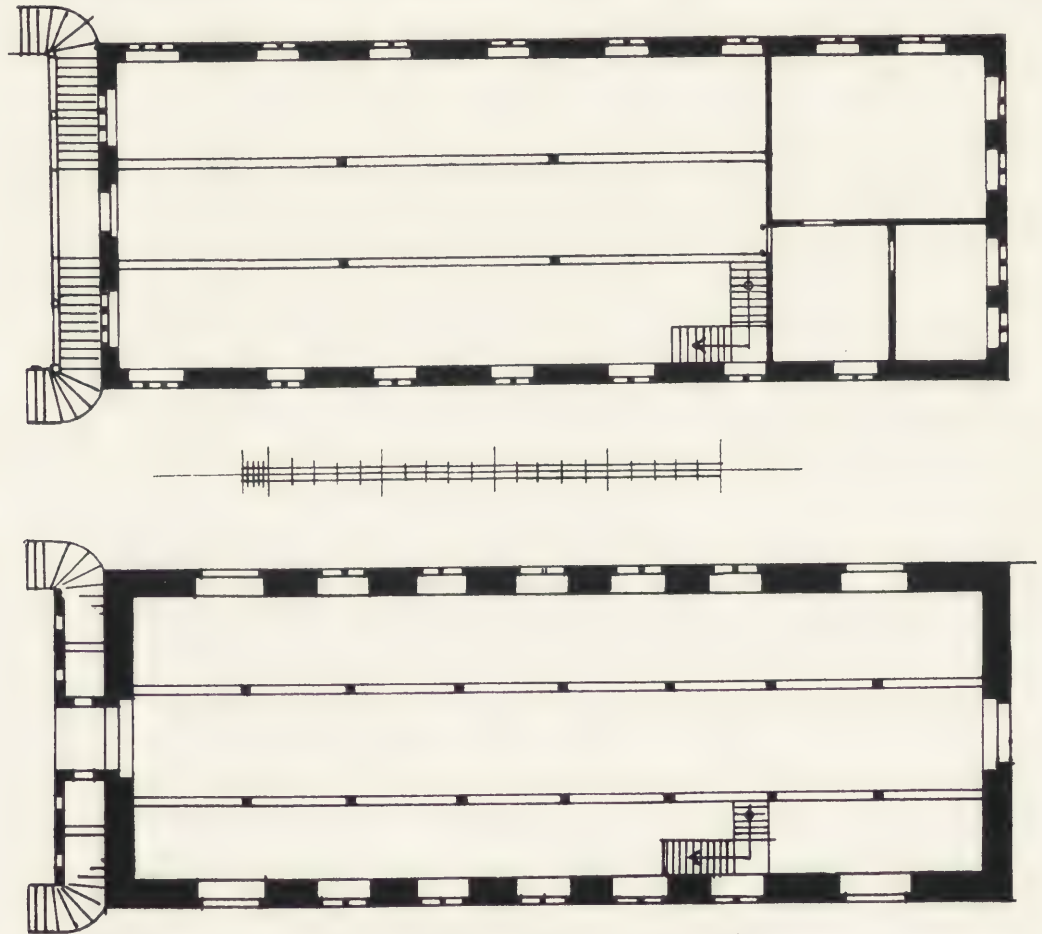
Rathaus zu Karlstadt. Grundrisse.
